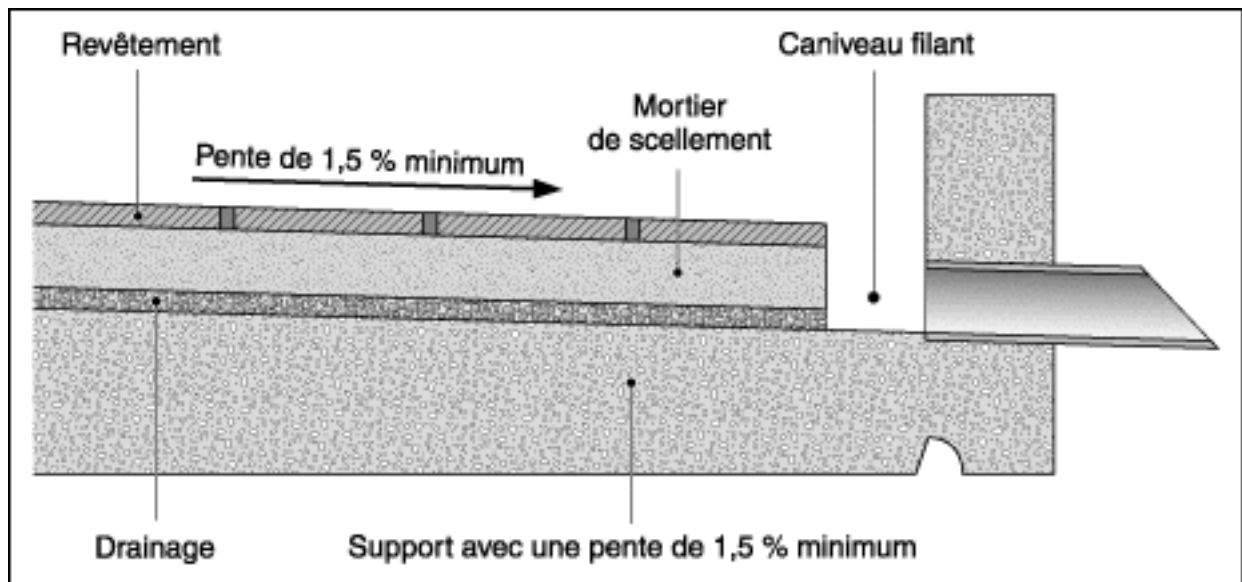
Arrêt du revêtement sur balcon bordé par un muret extérieur
